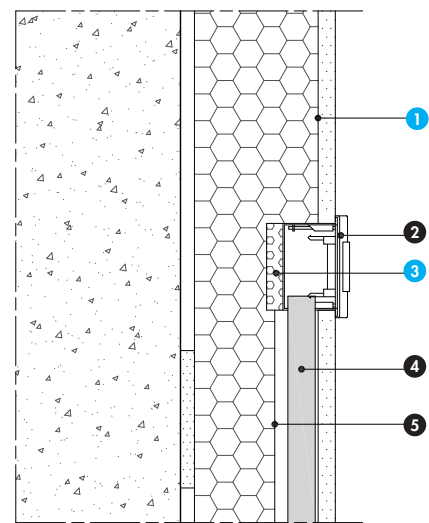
Étanchéité à l'air et des boîtiers électriques
